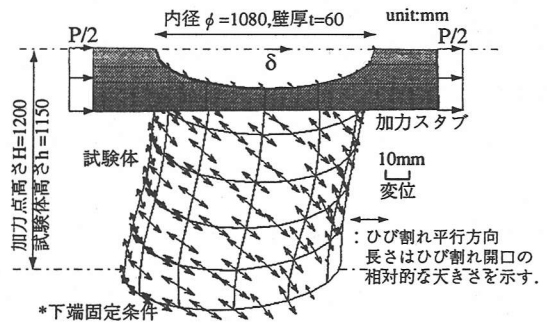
解析モデルと変形・ひび割れ—円形シェル—
